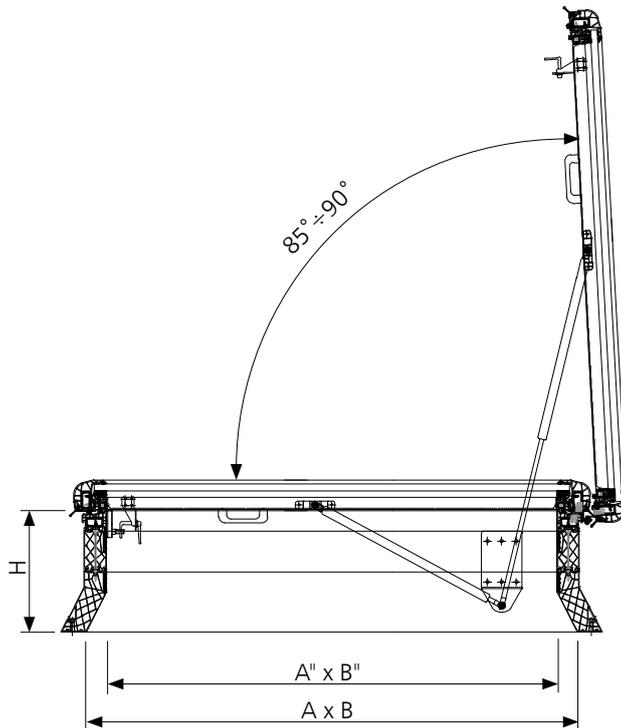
Schnitt B-B durch einen Dachausstieg mcr ULTRA THERM Typ NG-A in geöffneter Position
